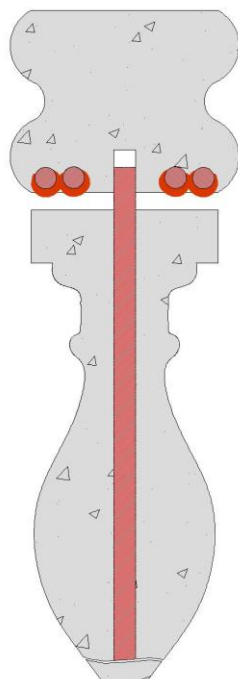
Esquema em corte da varanda degradada devido à corrosão das armaduras
